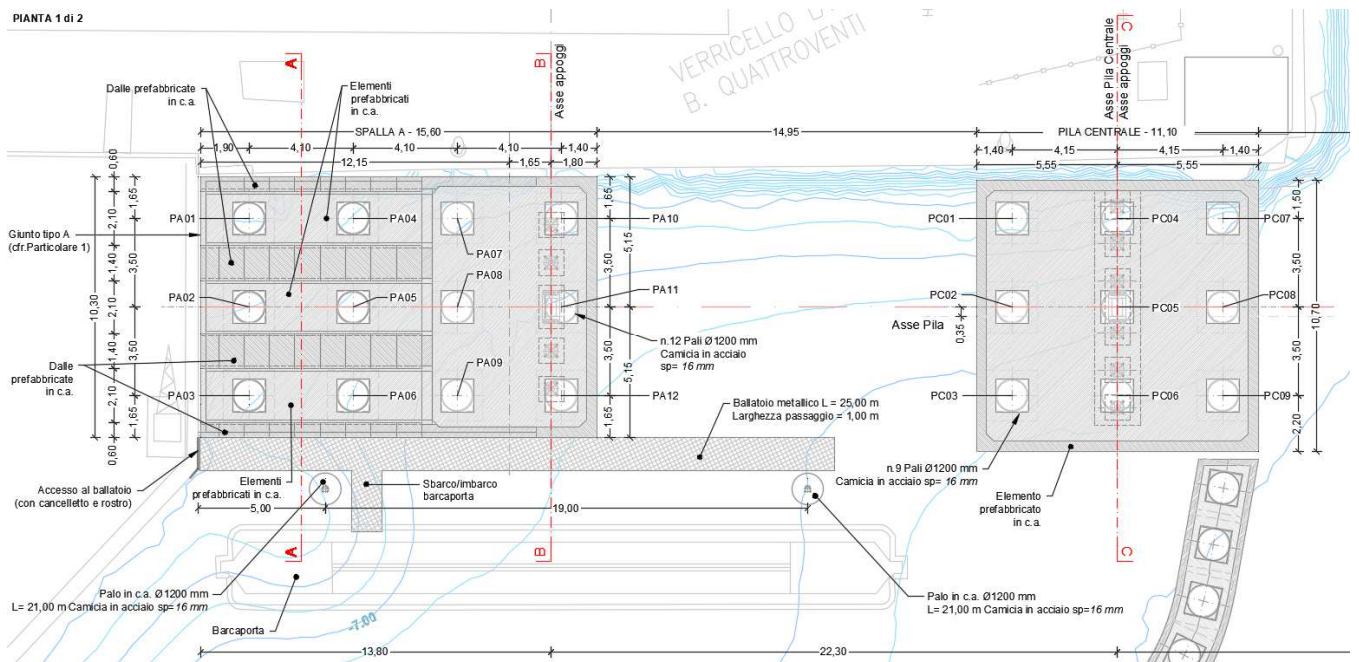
Planimetria della viabilità su pali: Stralcio 1 (Spalla A e Pila Centrale)
